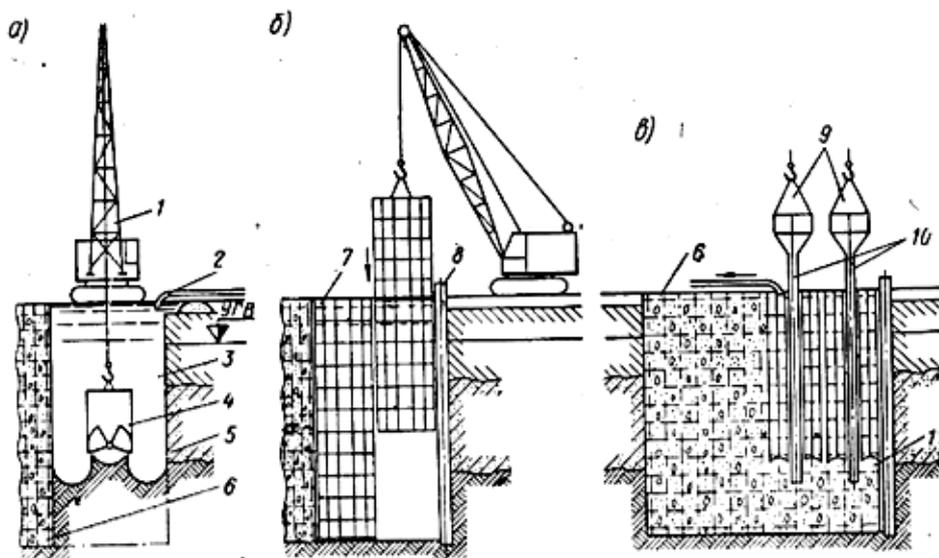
Метод «стена в грунте»: 1 – кран; 2 – трубопровод; 3 – глинистый раствор; 4 – грейфер; 5 – траншея под раствором; 6 – железобетонная стена в грунте; 7 – армокаркас; 8 – труба-перемычка; 9 – бункеры для бетона; 10 – бетонолитные трубы; 11 – бетонная смесь
